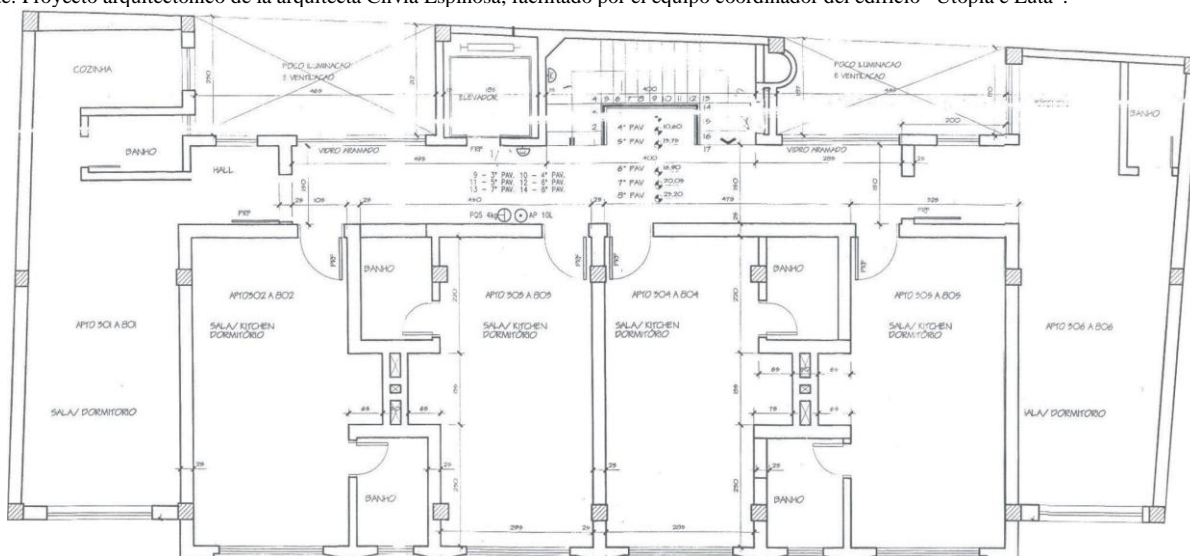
Plano de la Planta tipo del Edificio “Utopia e Luta”.
